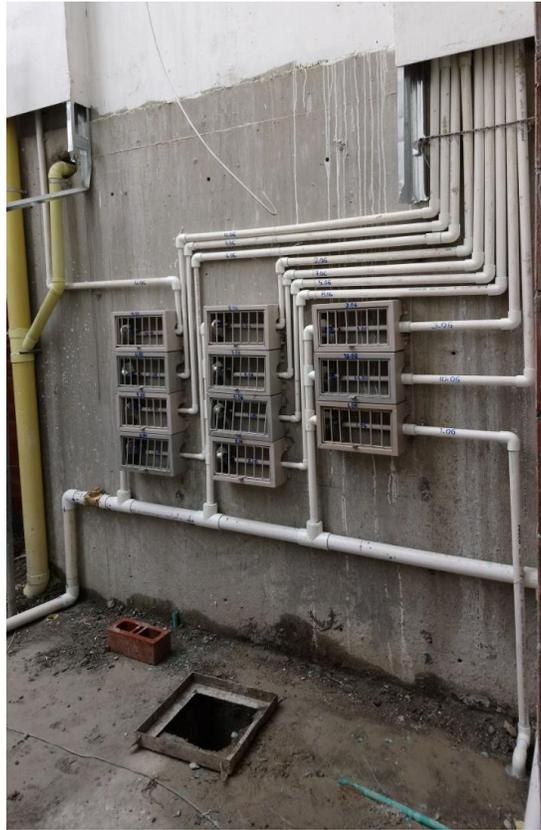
Tubería sanitaria y presión descolgada en losa locales.
